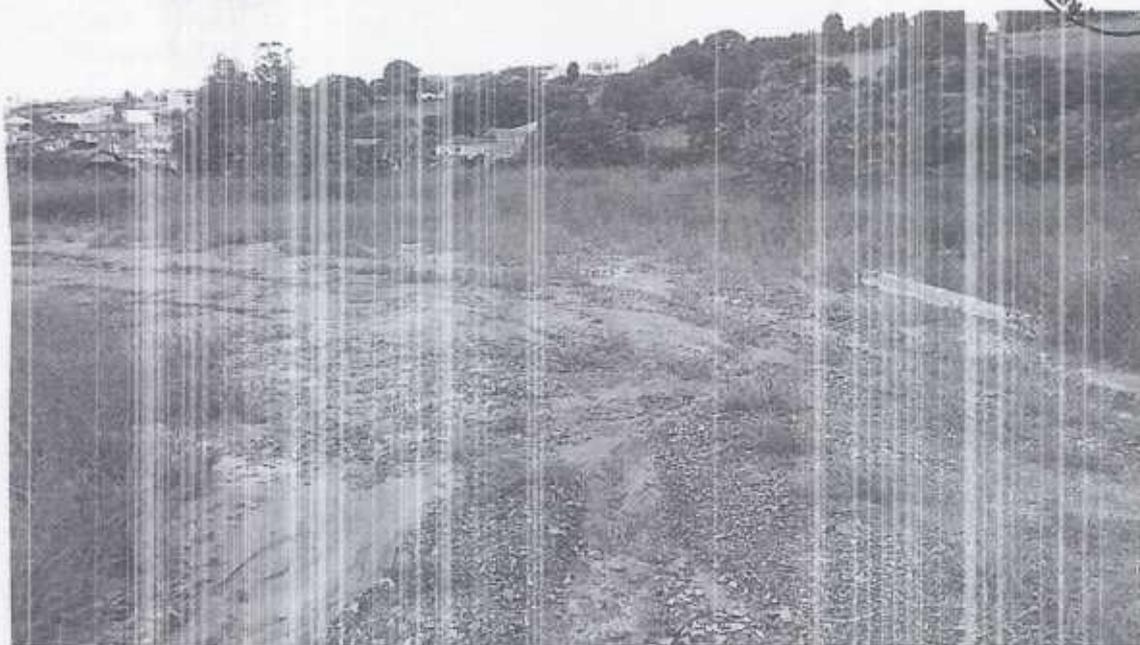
Rua 13 – Será demarcação da via, sem execução das guias e pavimento.
